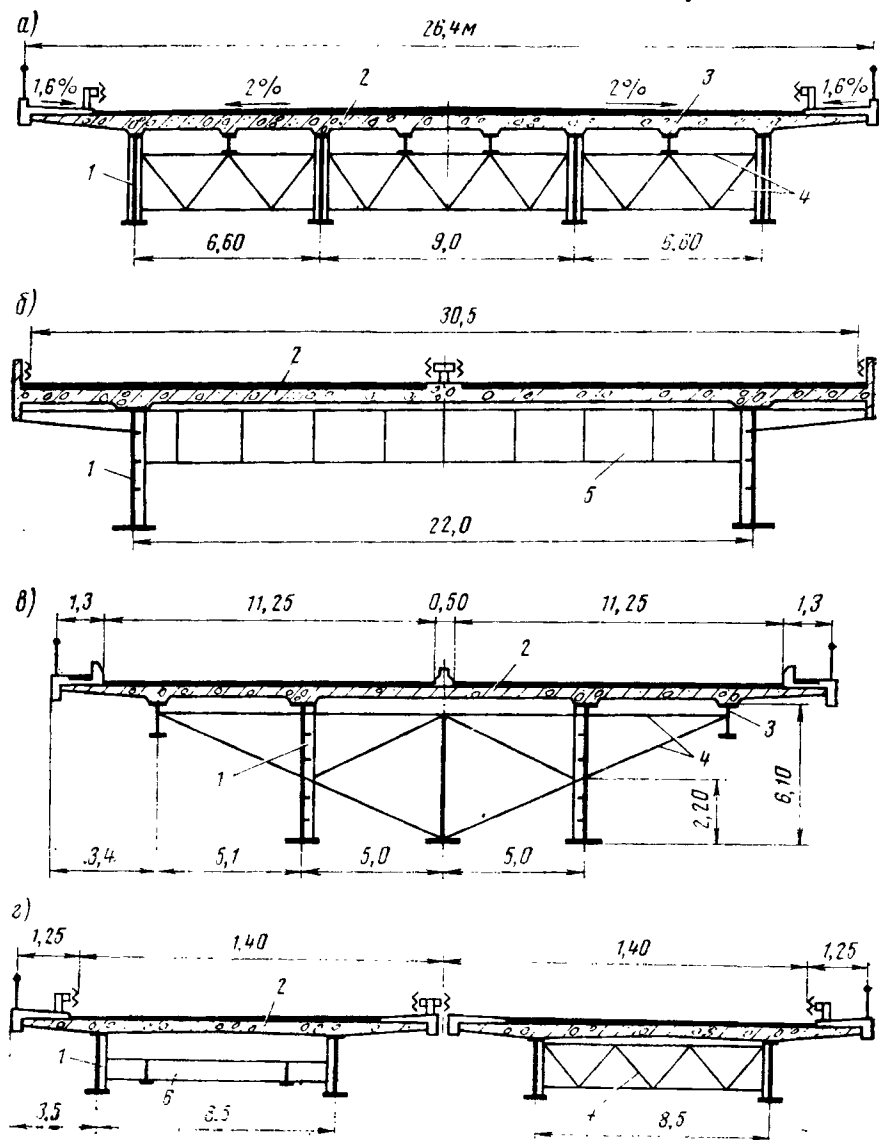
Поперечные сечения пролетных строений с открытым контуром и железобетонной плитой в проезжей части:
